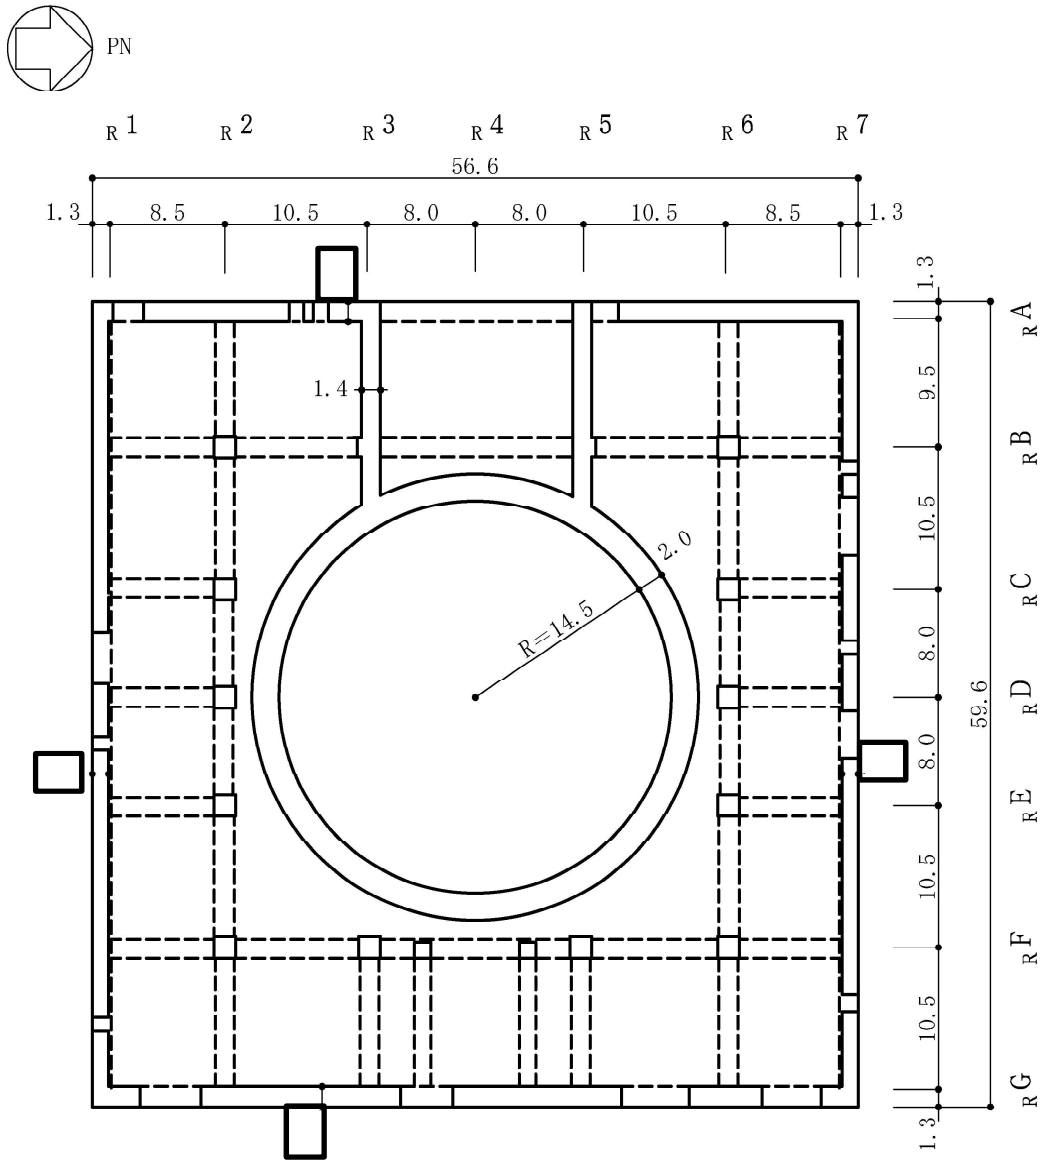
原子炉建屋の概略平面図 (1F, T.M.S.L. 12.3m) (4/9) (単位 : m)
